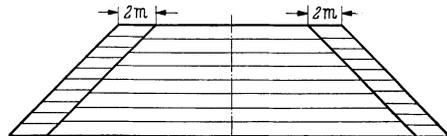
Dammschulterverdichtung unter Ermäßigung der Schütthöhe in einem etwa 2 m breiten Randstreifen, um die Dammschultern durch mittelschweres Gerät verdichten zu können.
